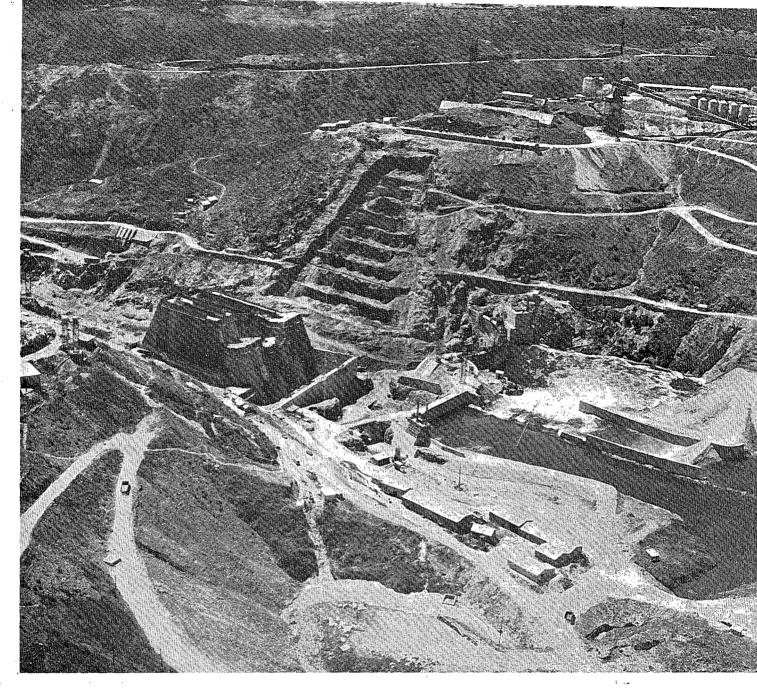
Excavación estribo derecho. (Right abutment excavation).
